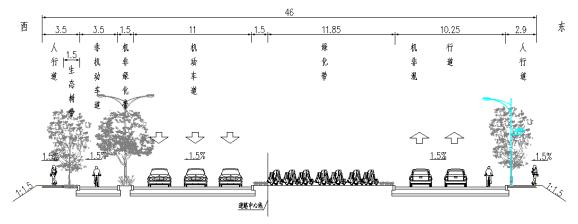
康园路(桩号 0+480-0+530) 横断面示意图
